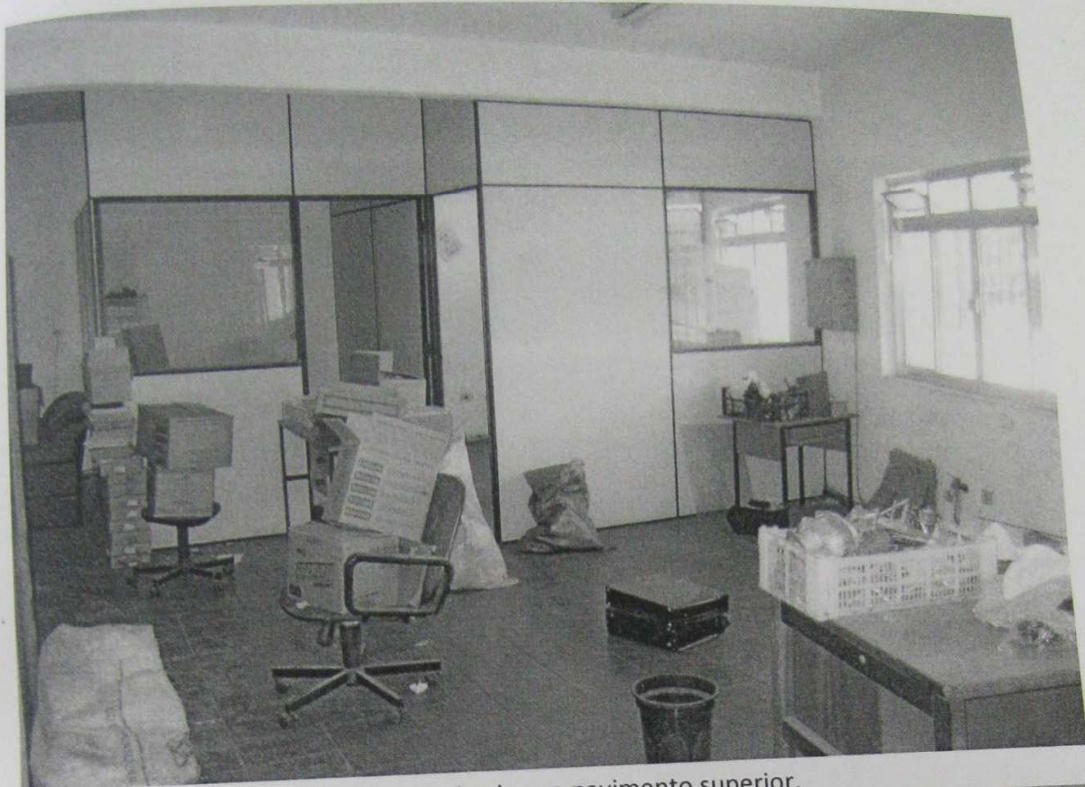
Outra vista da Área de escritorios no pavimento superior.
